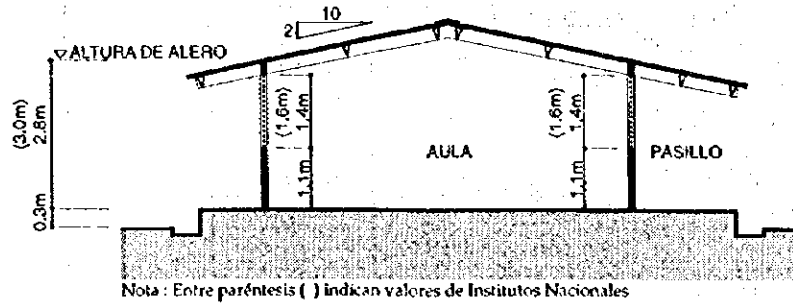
SECCION TIPICA DEL EDIFICIO DE AULAS
